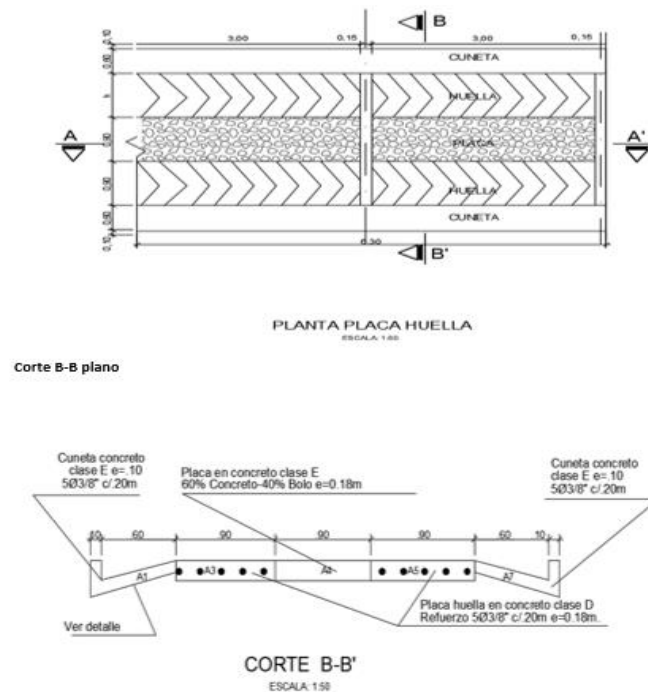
Planos de diseño para la construcción de las placa-huellas. Adaptado de Planos de la Secretaría de Infraestructura del municipio de Piedecuesta, Santander, 2019.
